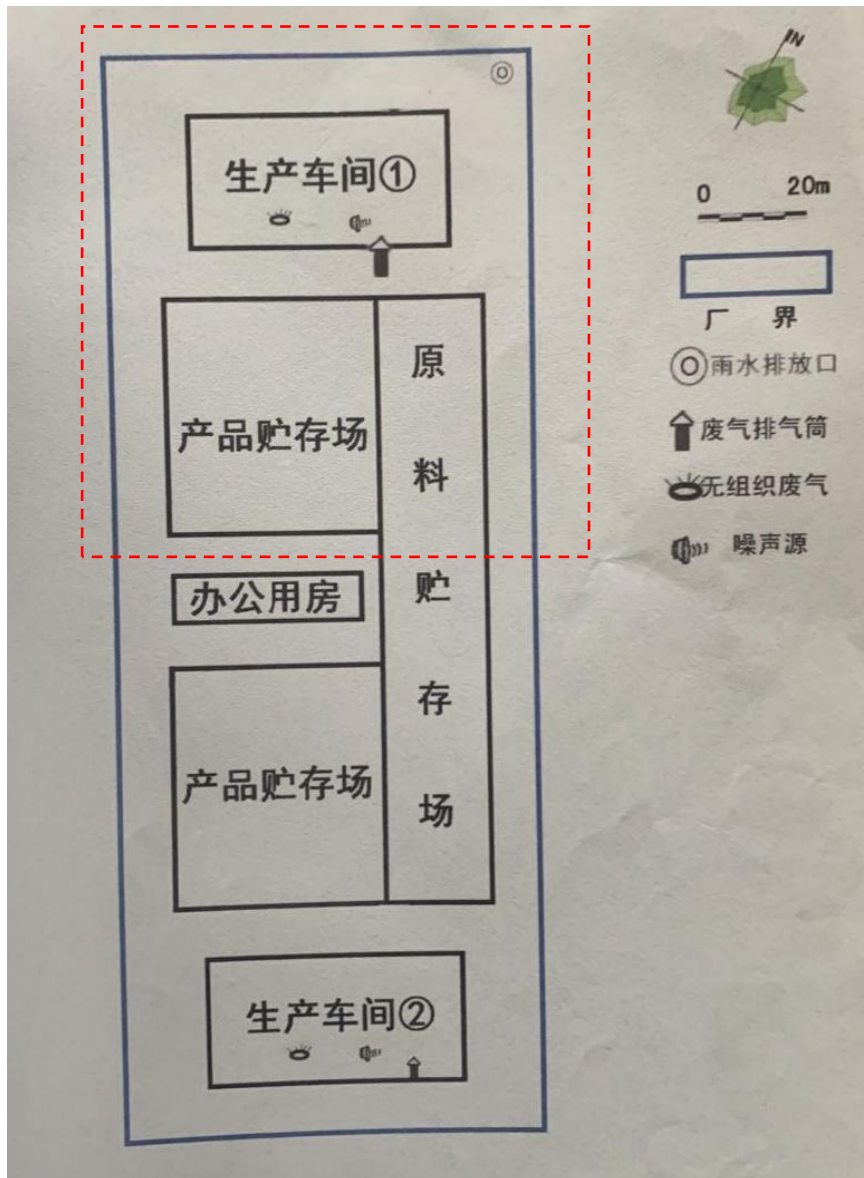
厂区平面布置图 (为第一阶段验收范围)
